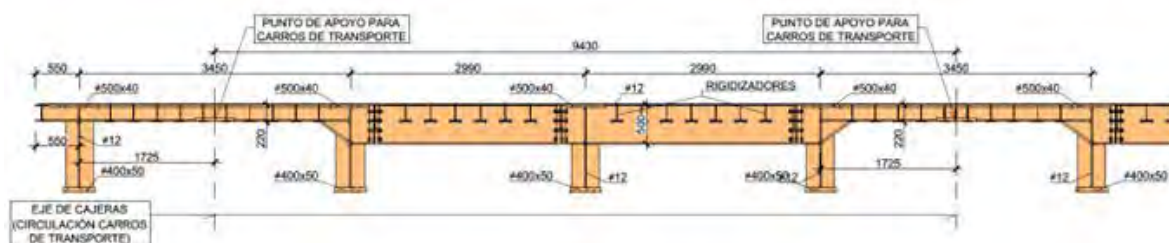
Sección longitudinal de bandeja por vigas transversales.
